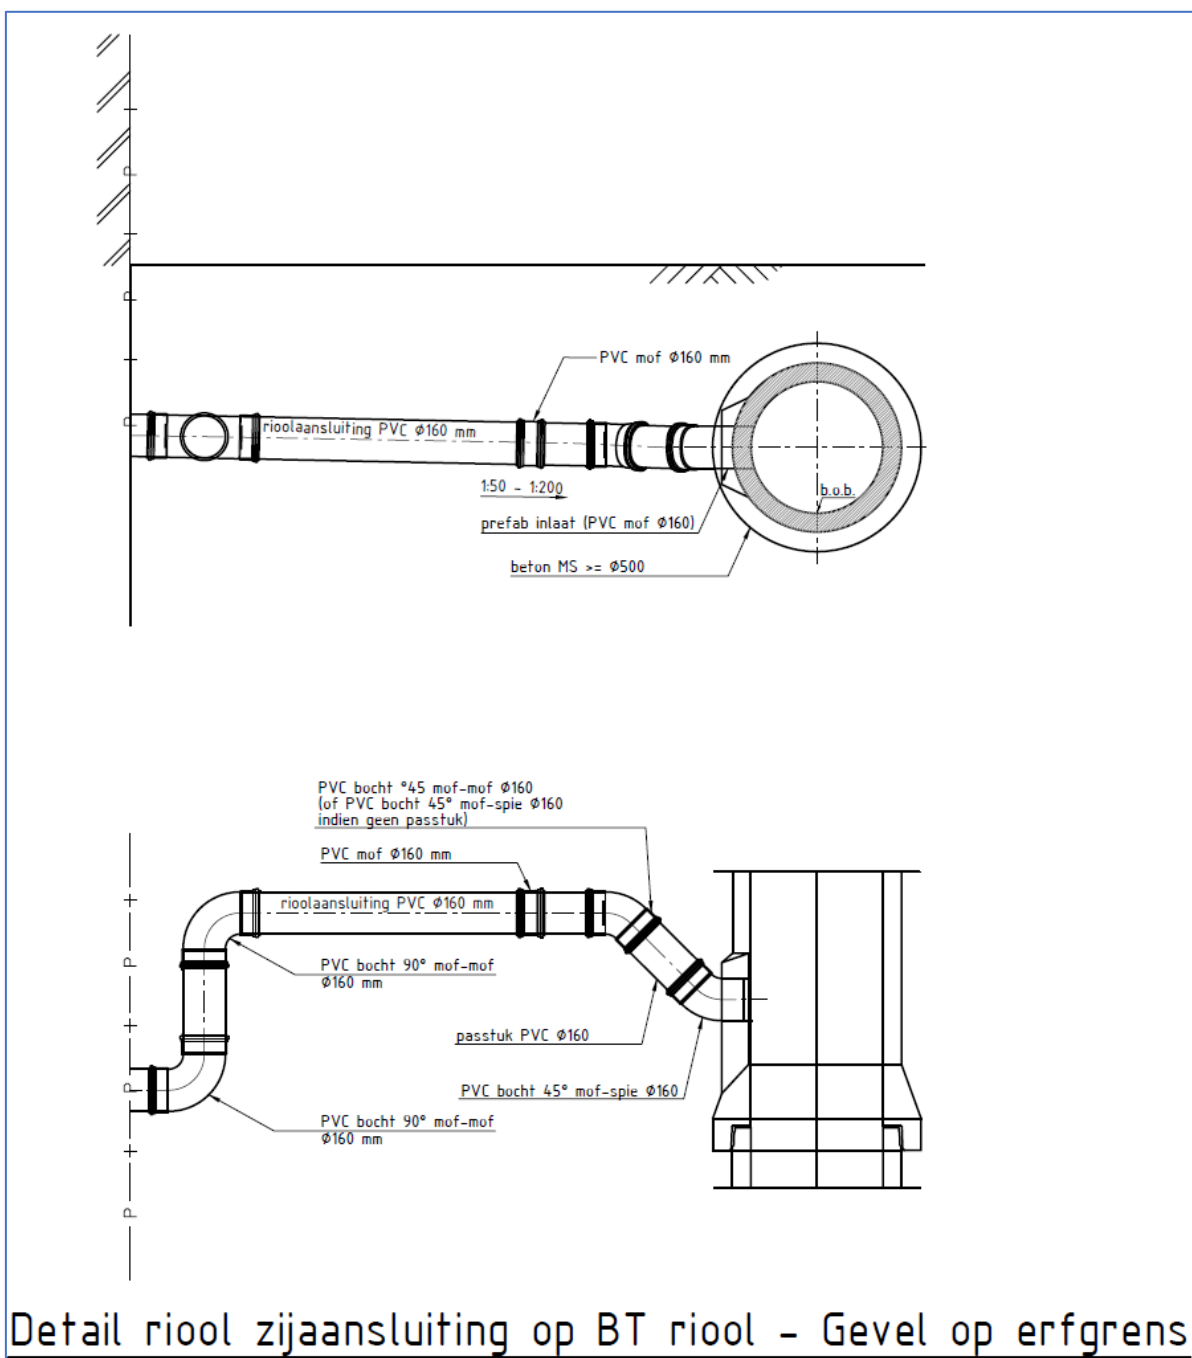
Detail riool zijaansluiting 45 graden op betonnen riool, erfgrens op gevel.
